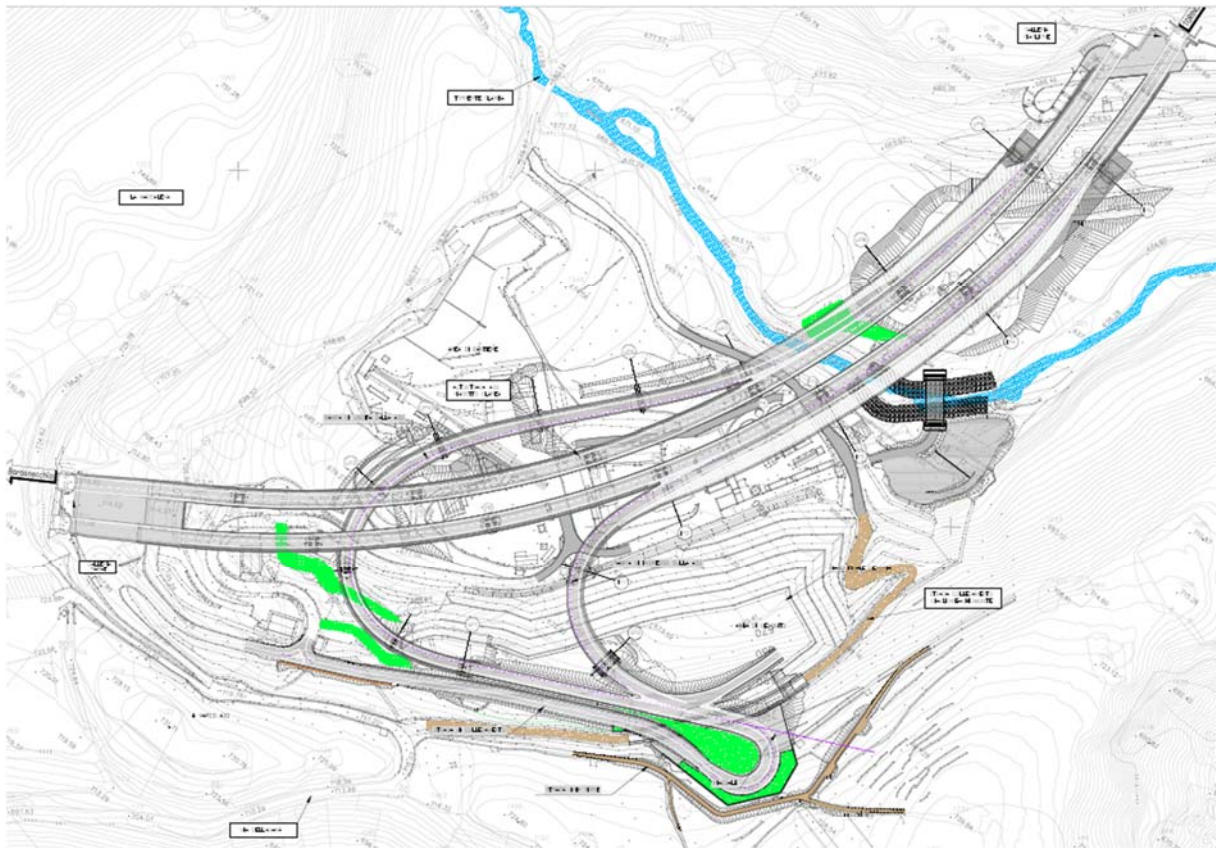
Stralcio planimetrico dello Svincolo della Maddalena
